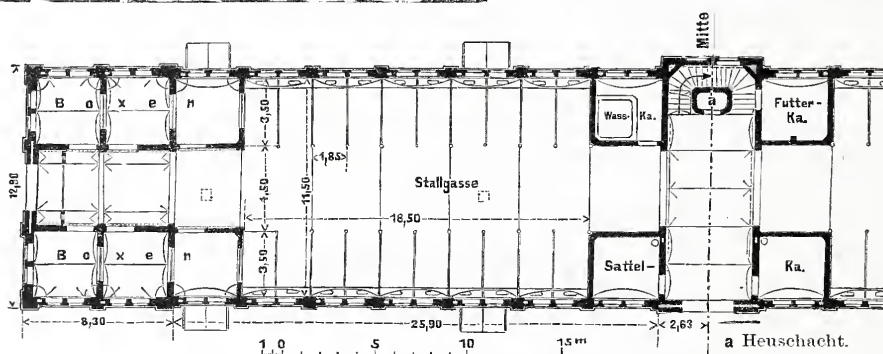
Hengstestall. Grundriss des Erdgeschosses.
